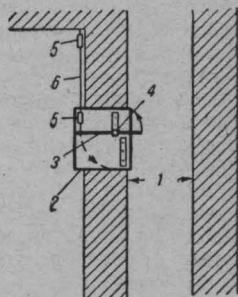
Автоматически закрывающаяся заслонка (поворачивающаяся).
